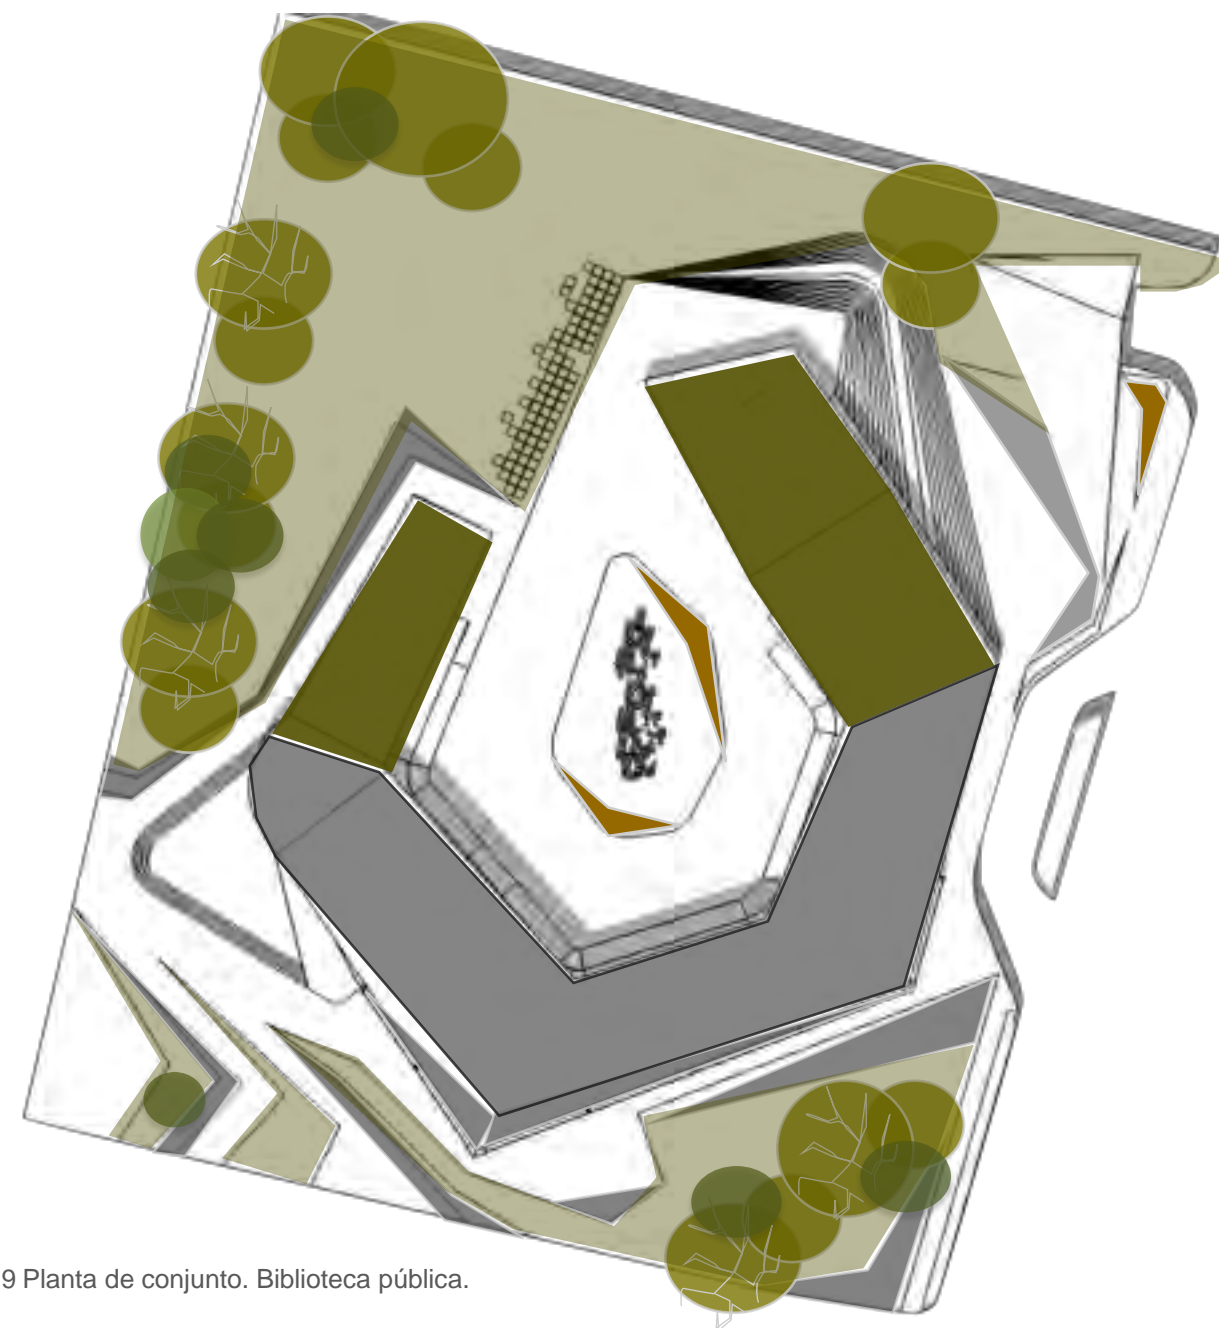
Planta de conjunto. Biblioteca pública.
